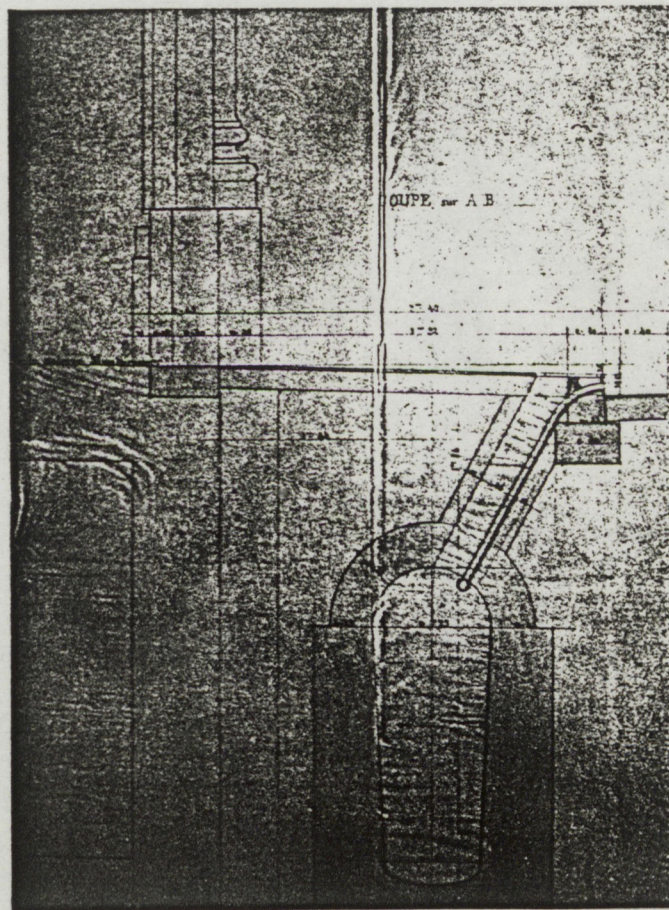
"Plan et détails pour l'exécution du trottoir au niveau des galeries : détails d'une bouche à clé", P. Chabrol, architecte avril 1857
